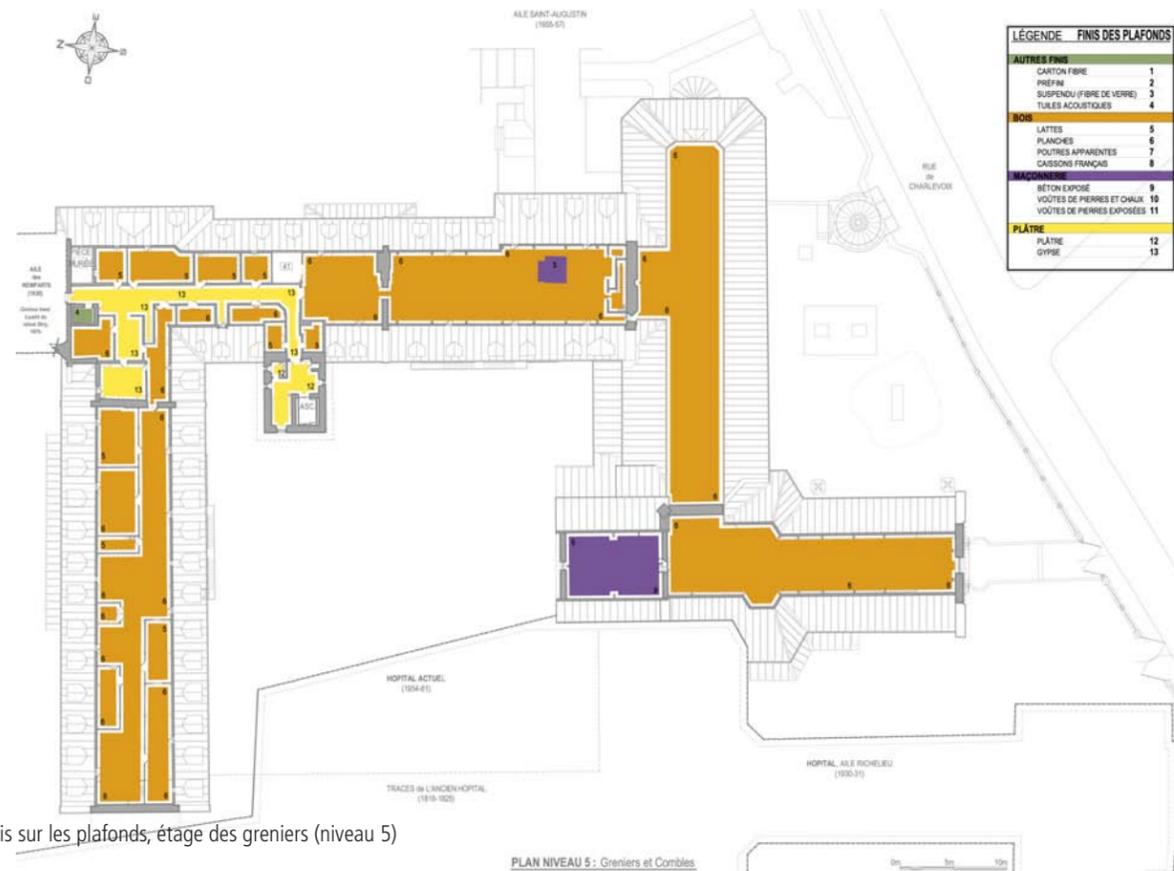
Plan des finis sur les plafonds, étage des greniers (niveau 5)
